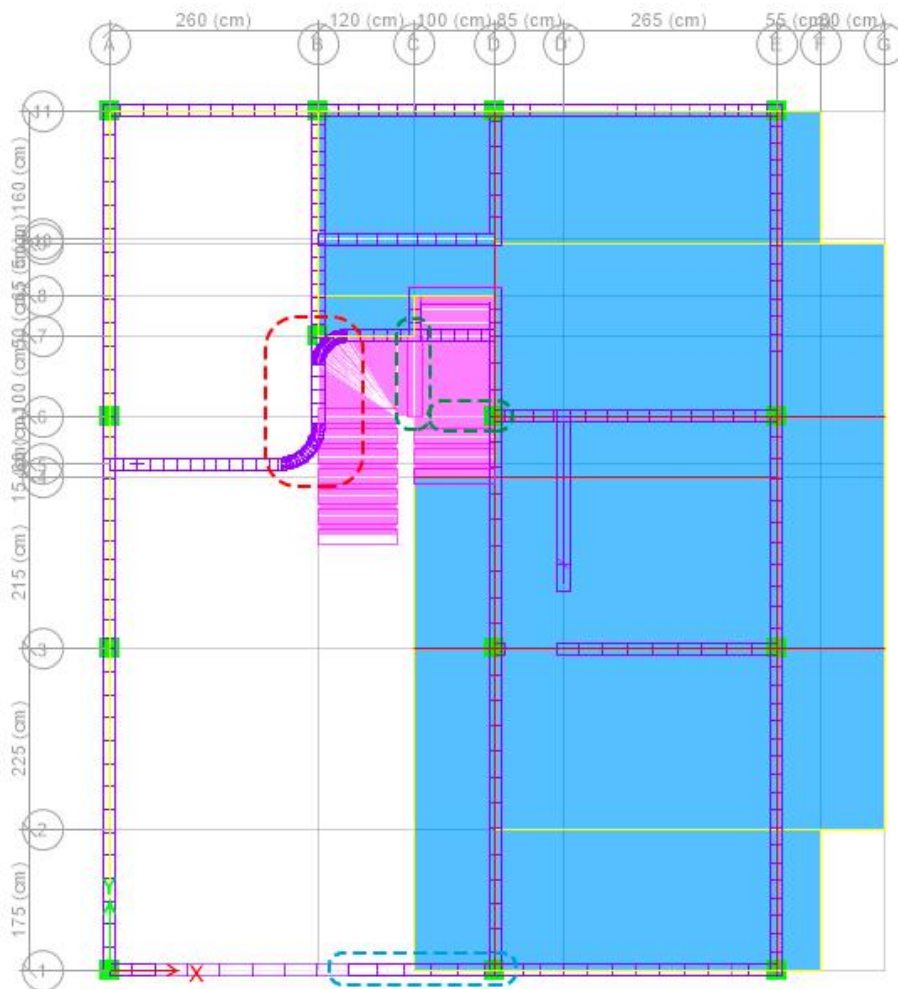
Esquema Estructural en Planta – Modelación N°2 ETABS 2016.
